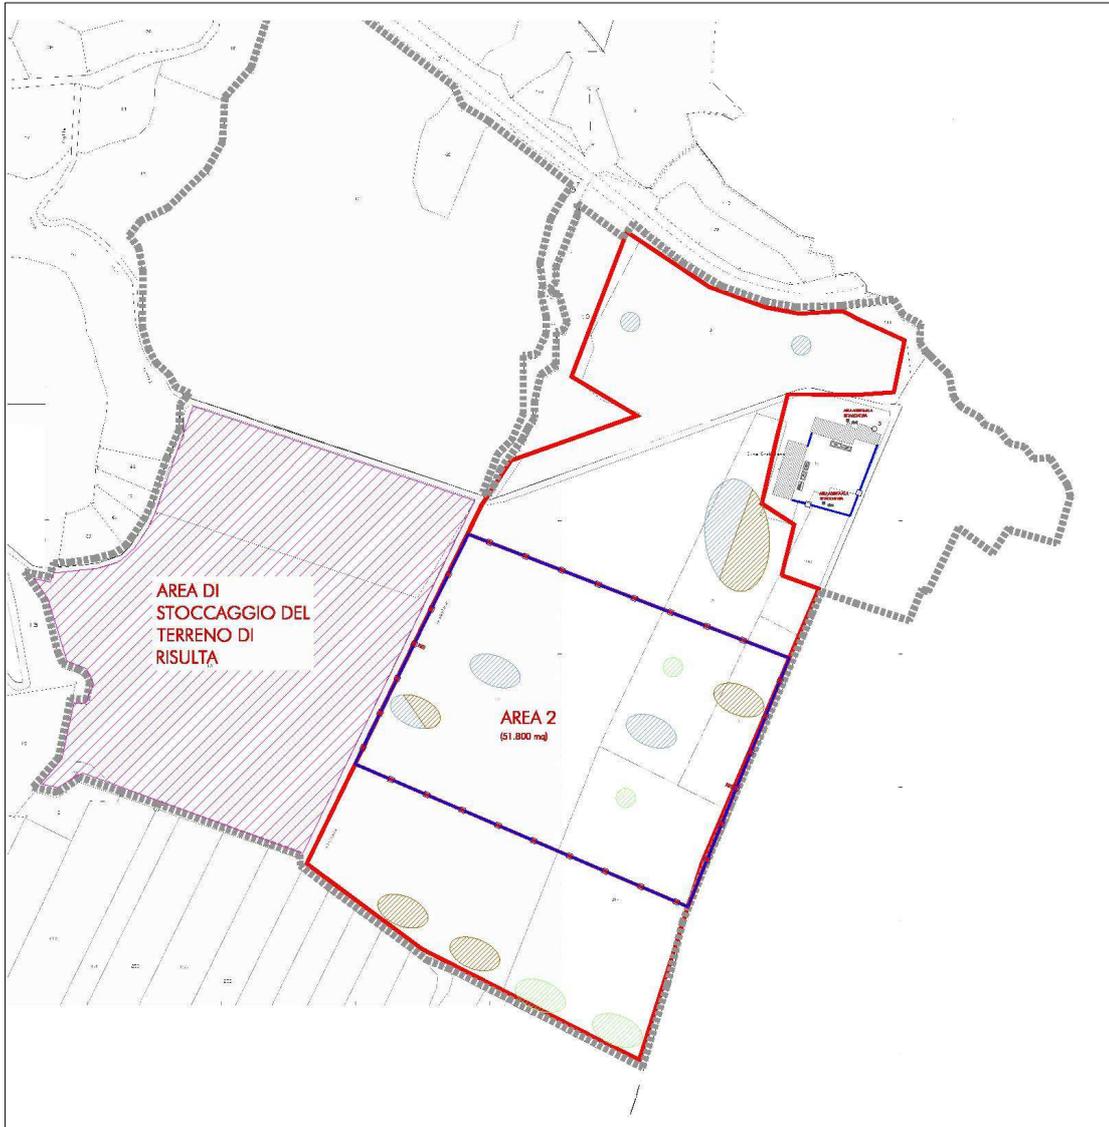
Planimetria generale della terza fase di scavo – Area 2
